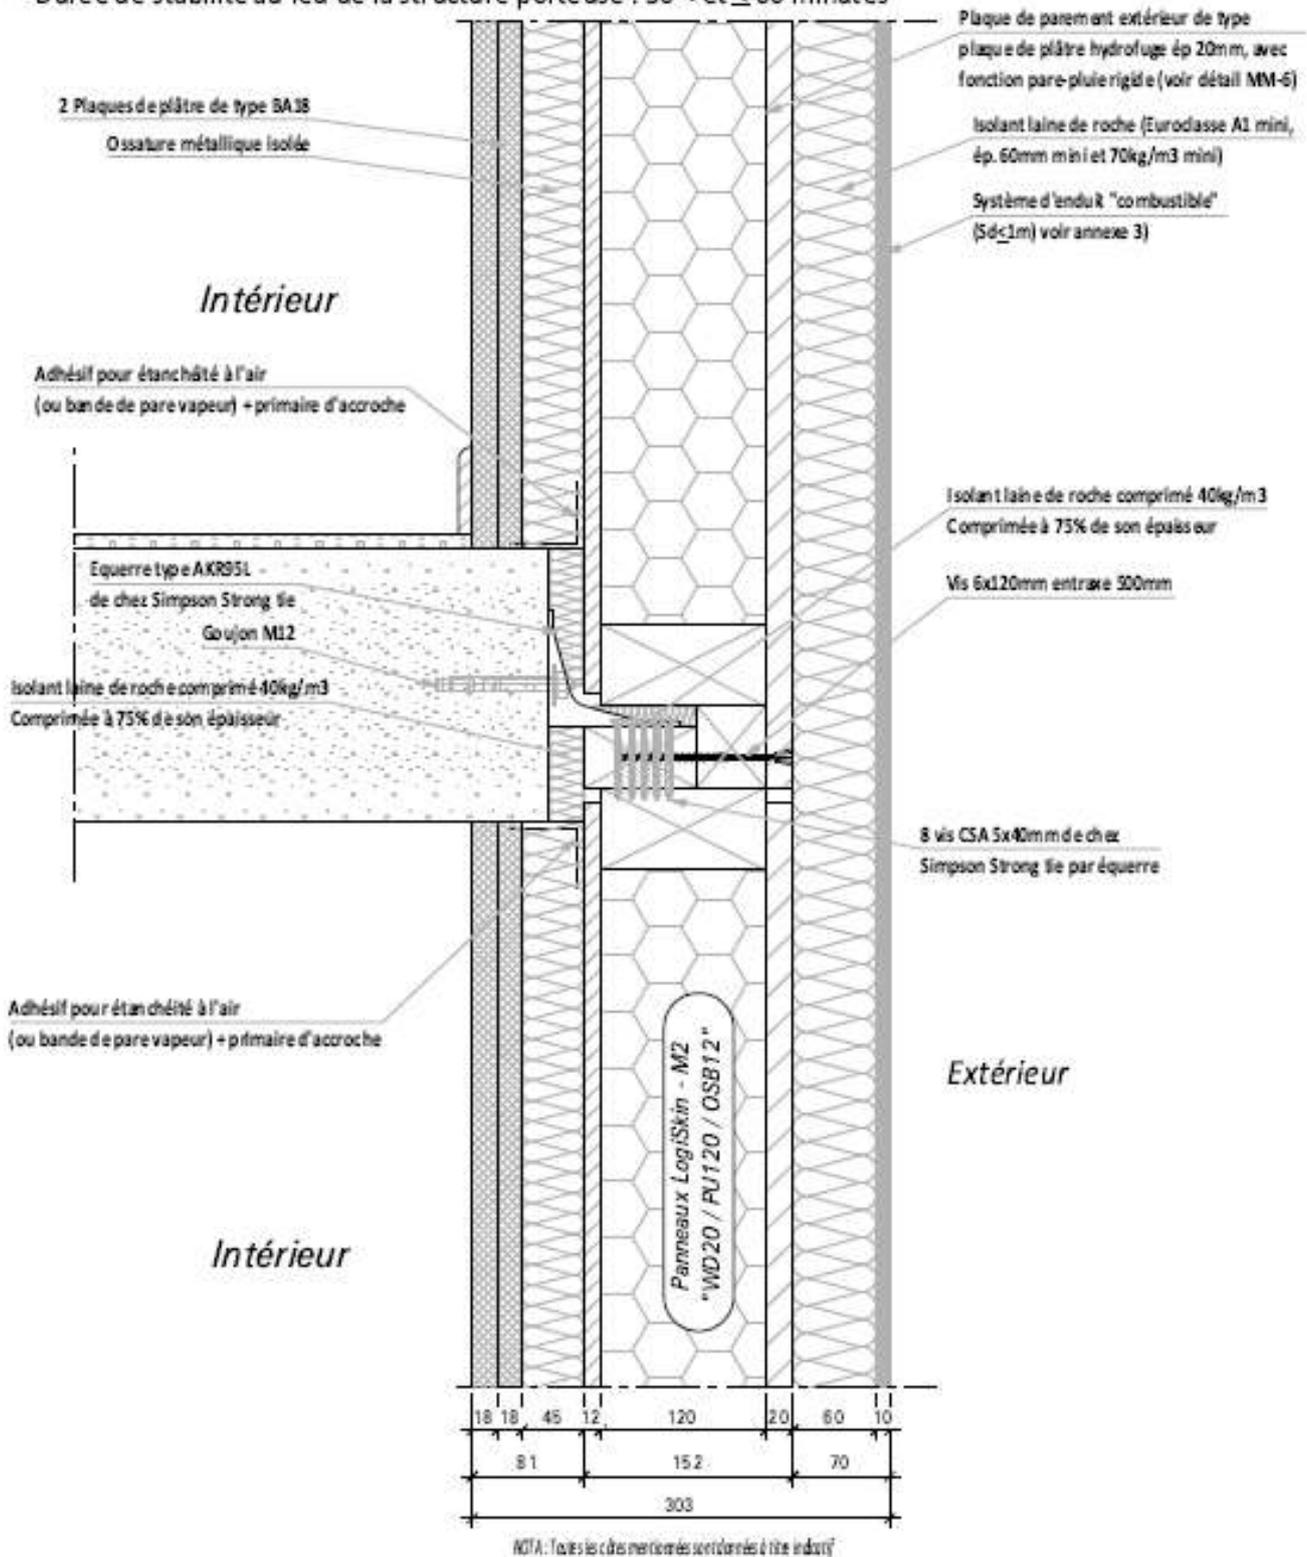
Détail CV-2.6 – jonction avec plancher (mode de pose 1)
